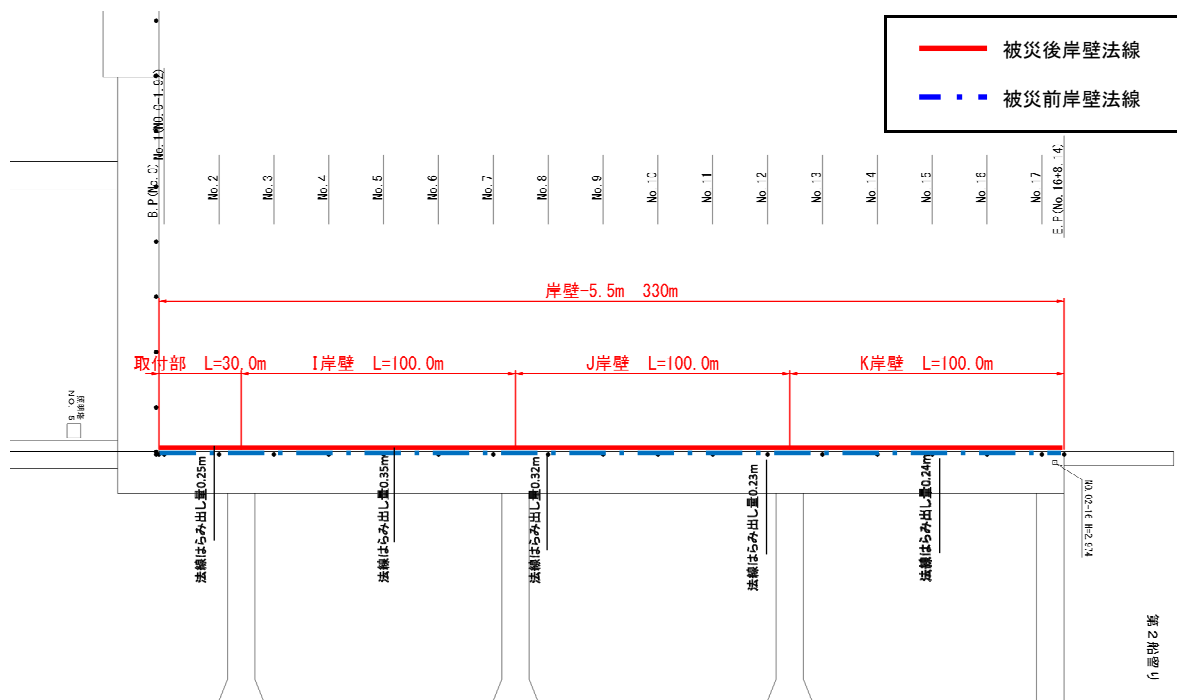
No.18 常陸那珂港区\_北ふ頭地区岸壁 (-5.5m) I,J,K の平面図 (被災後)
